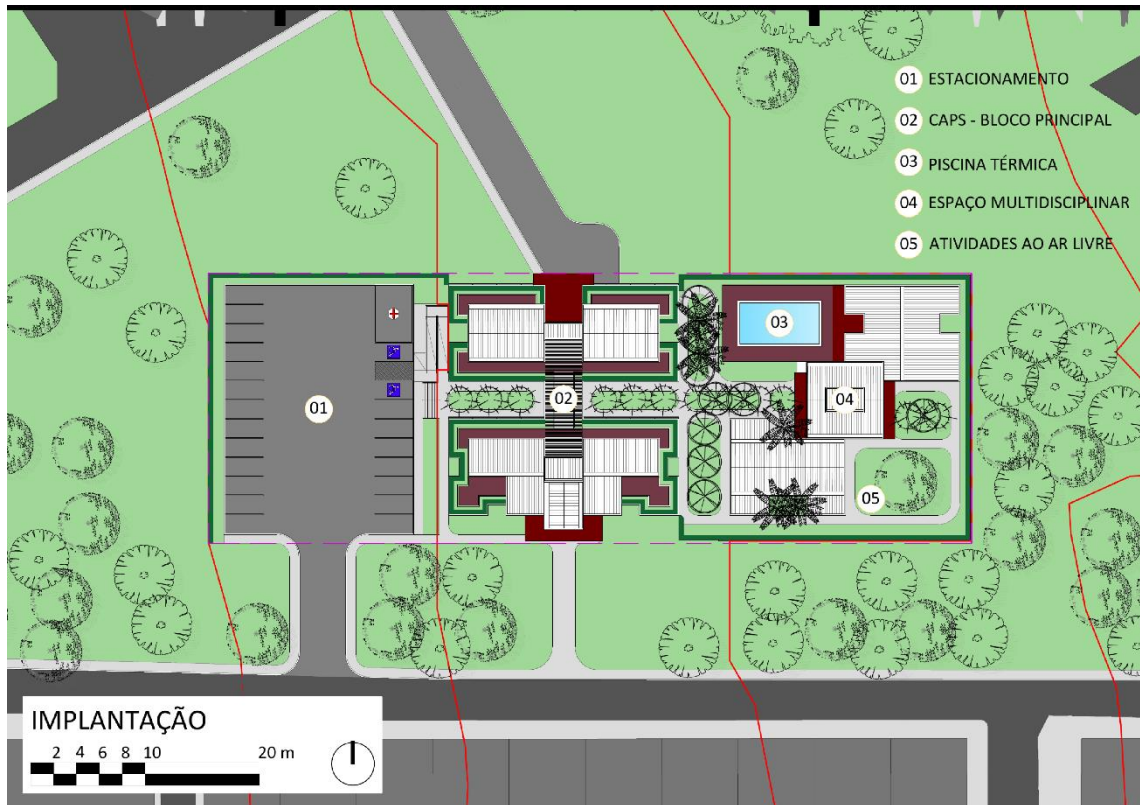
PLANTA DE IMPLANTAÇÃO. FONTE: AUTORAL.
